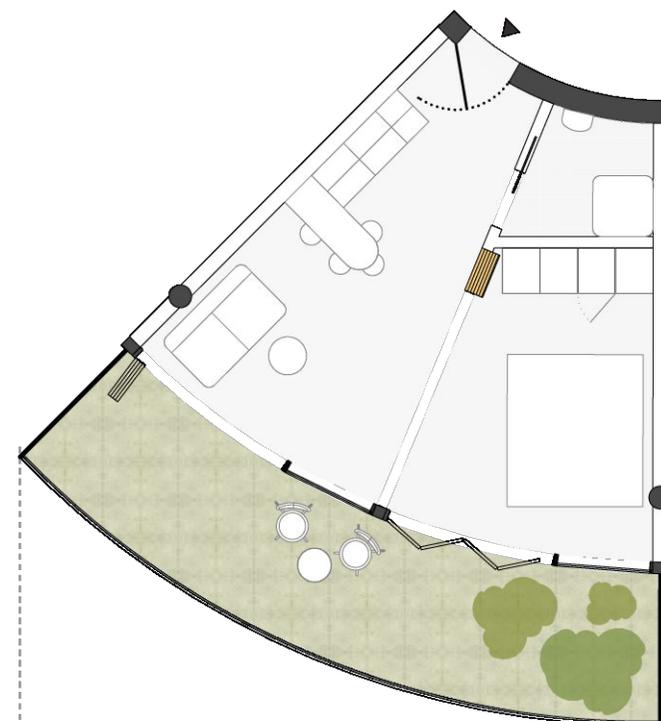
Grundriss Wohnung Typ A.a, offen
